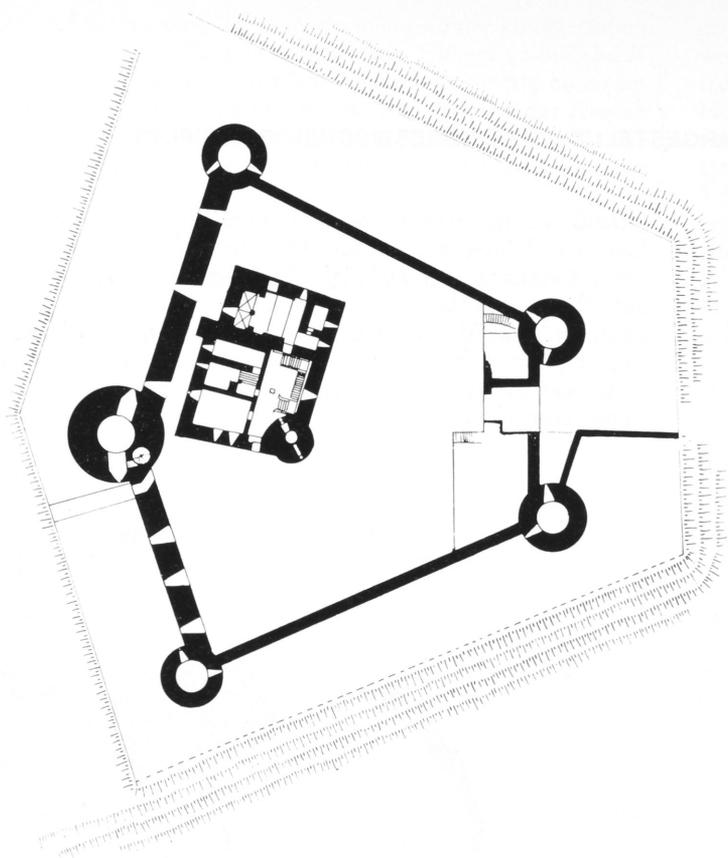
Burg Trendelburg (Kr. Hofgeismar), fünfeckige Höhenburg mit Halsgraben im Westen, Neubau Mitte 15. Jh., Lageplan 1:1000
